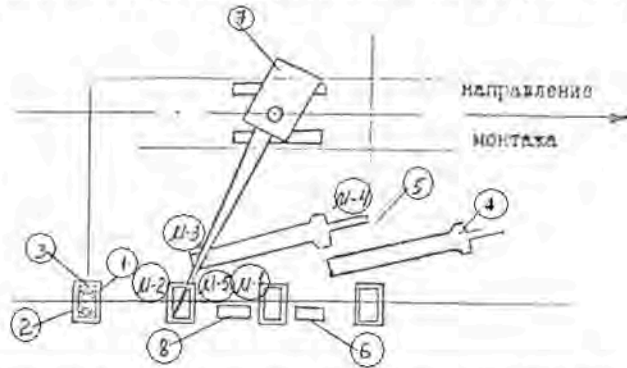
Пример схемы организации рабочего места монтажников при монтаже колонн каркаса здания (железобетонные колонны).
